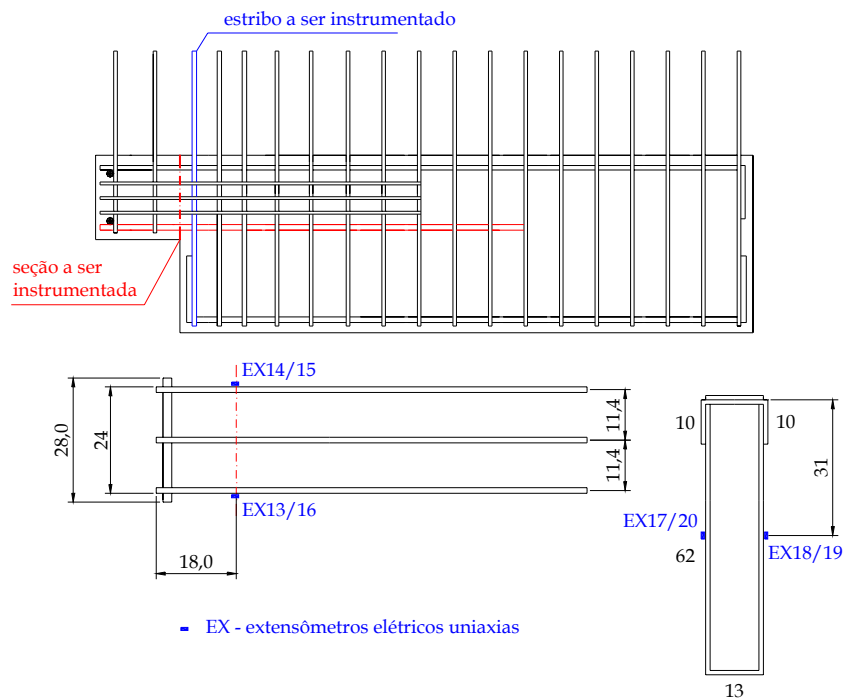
Instrumentação da armadura das vigas (dimensões em cm).
